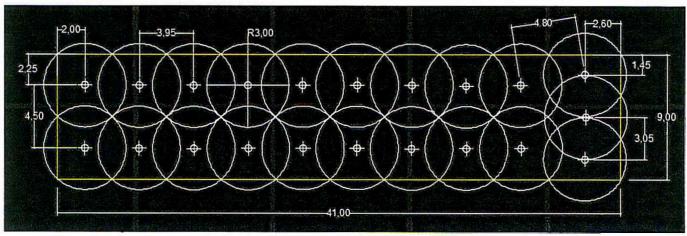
Vista de planta, distribución de los pozos para airear el área impactada A-1.
